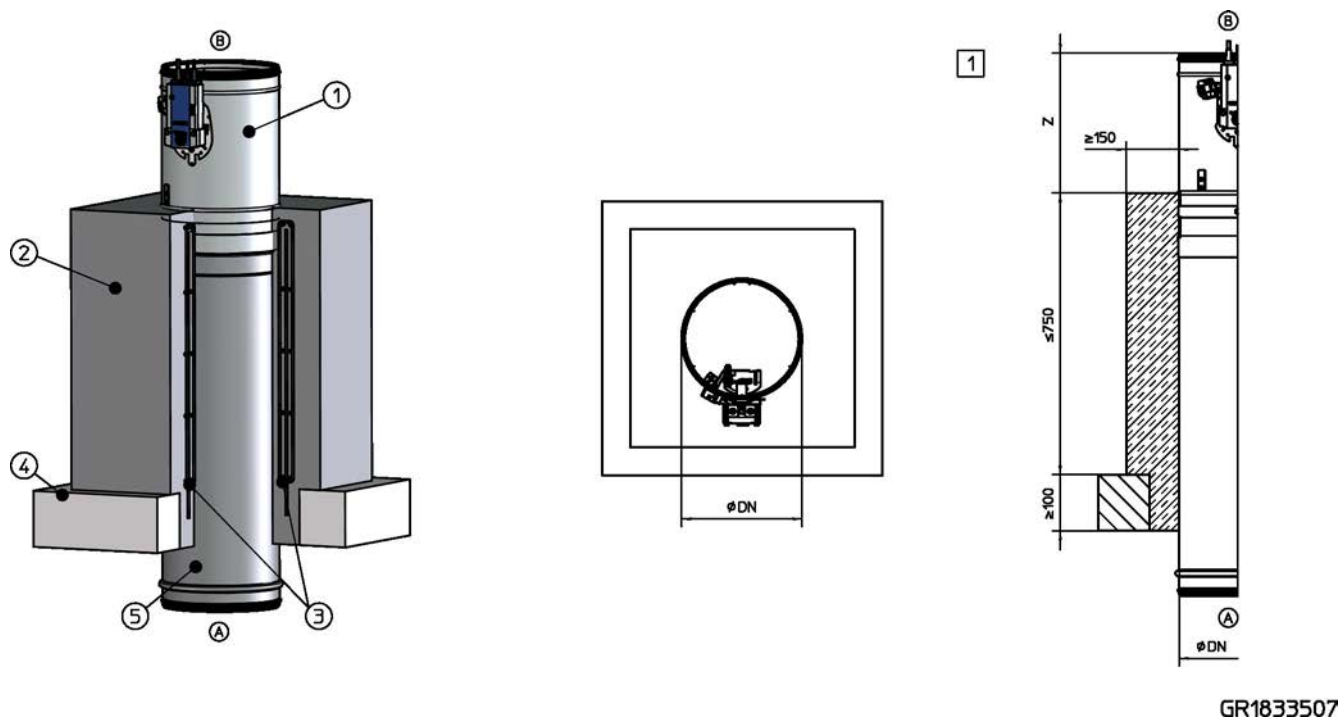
Installation à base de mortier avec une base en ciment dans un plafond plein, jusqu'à EI 120 S
